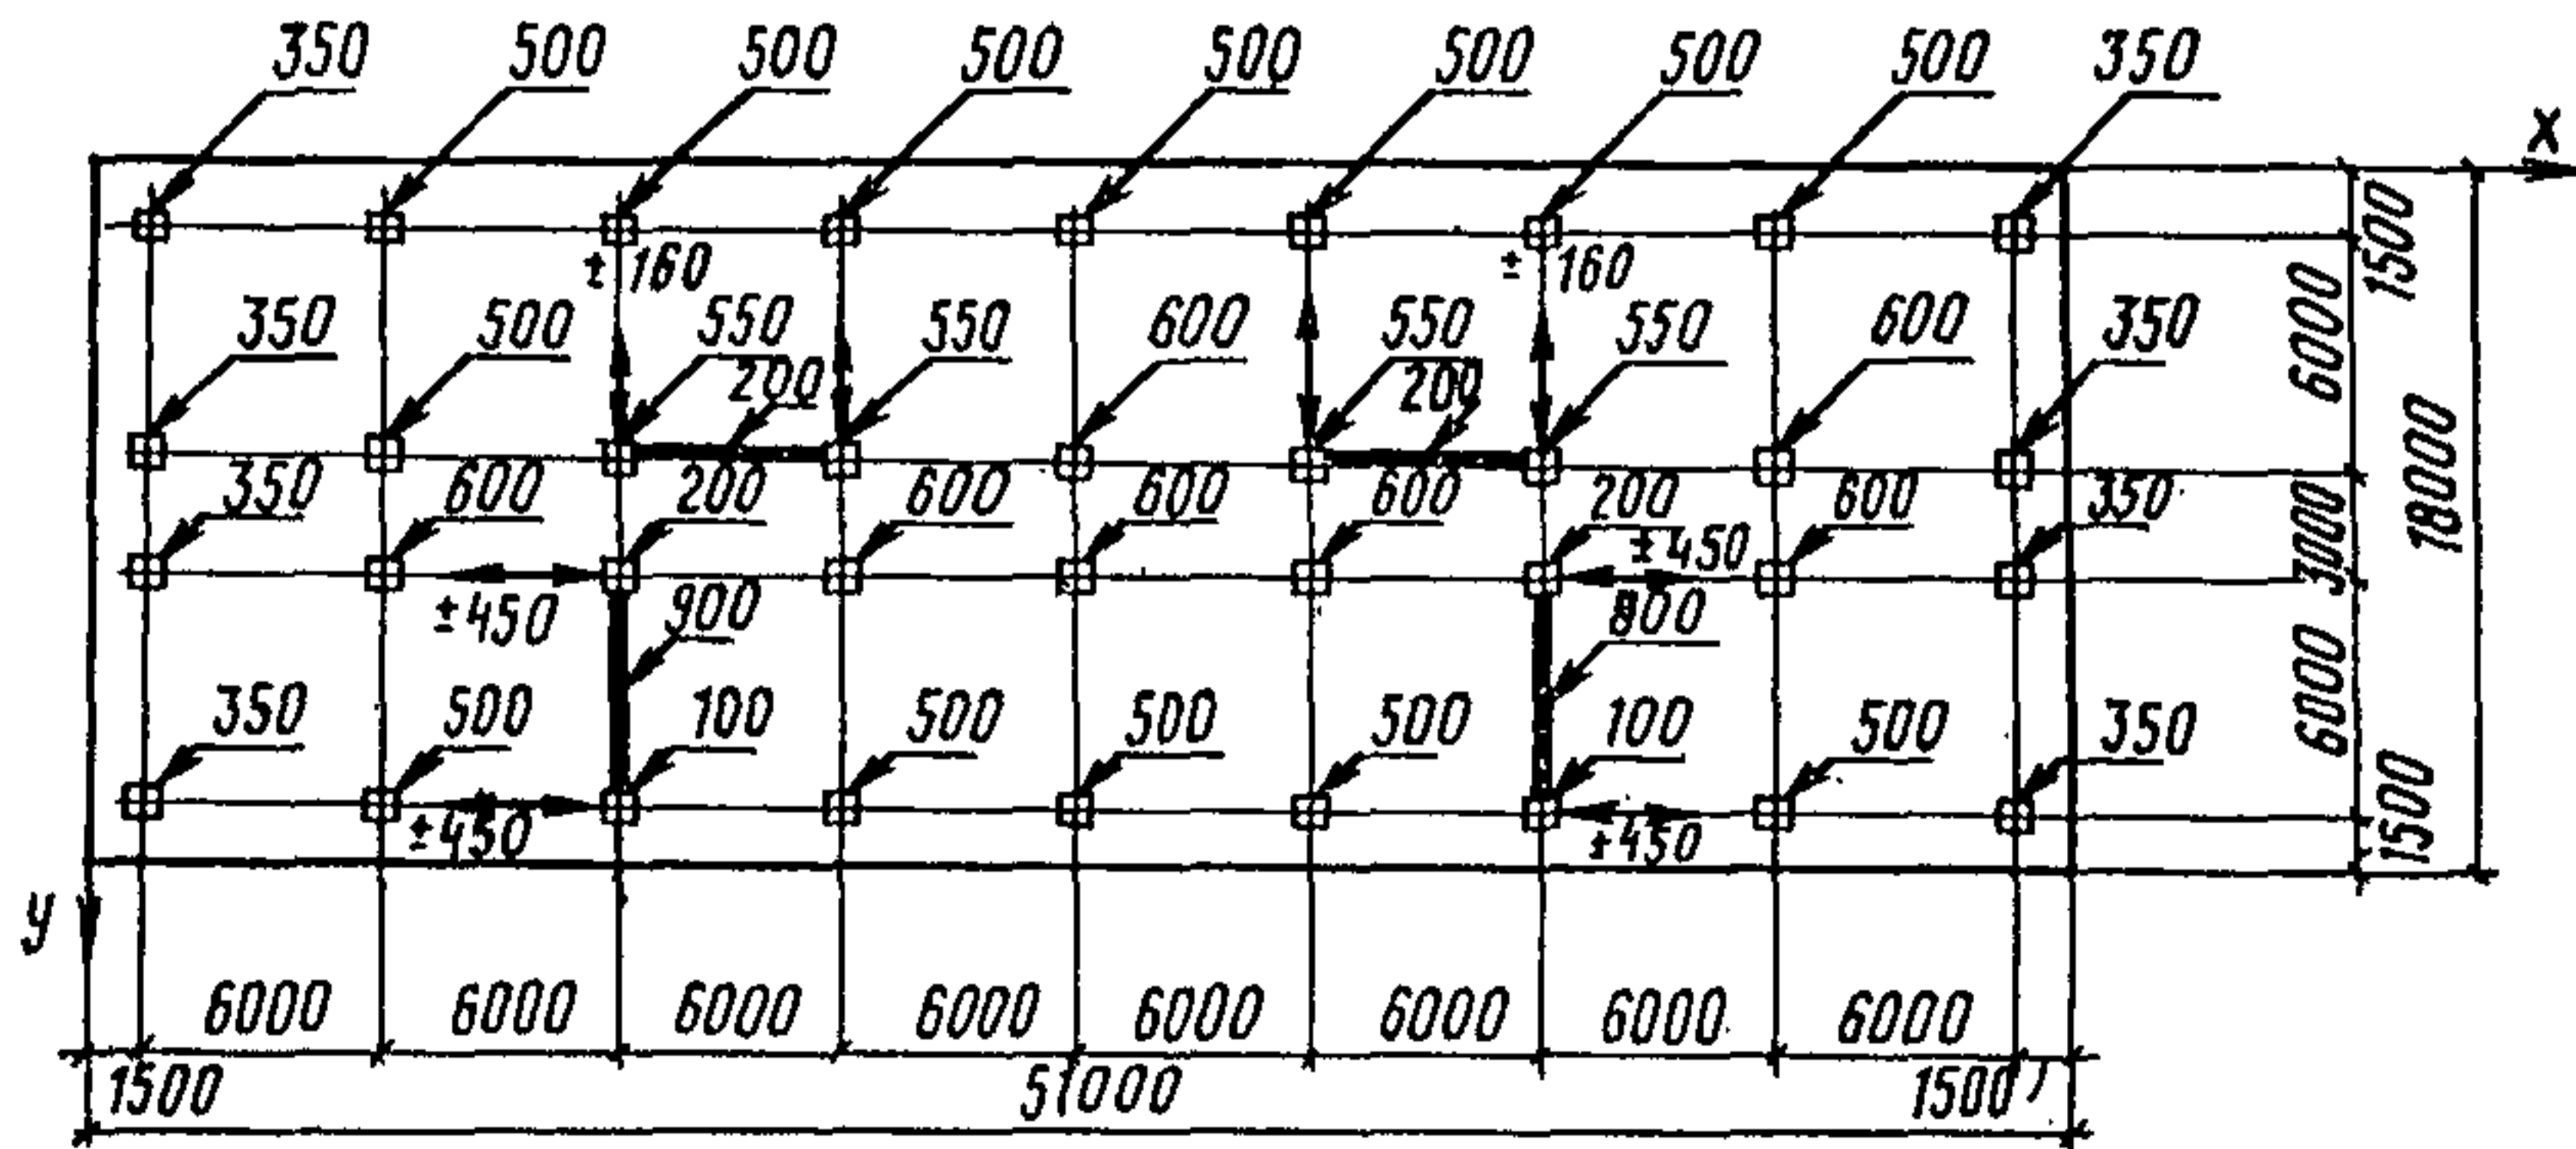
Схема нагрузок, передаваемых на фундаментную плиту колоннами каркаса и диафрагмами жесткости 16-этажного здания
